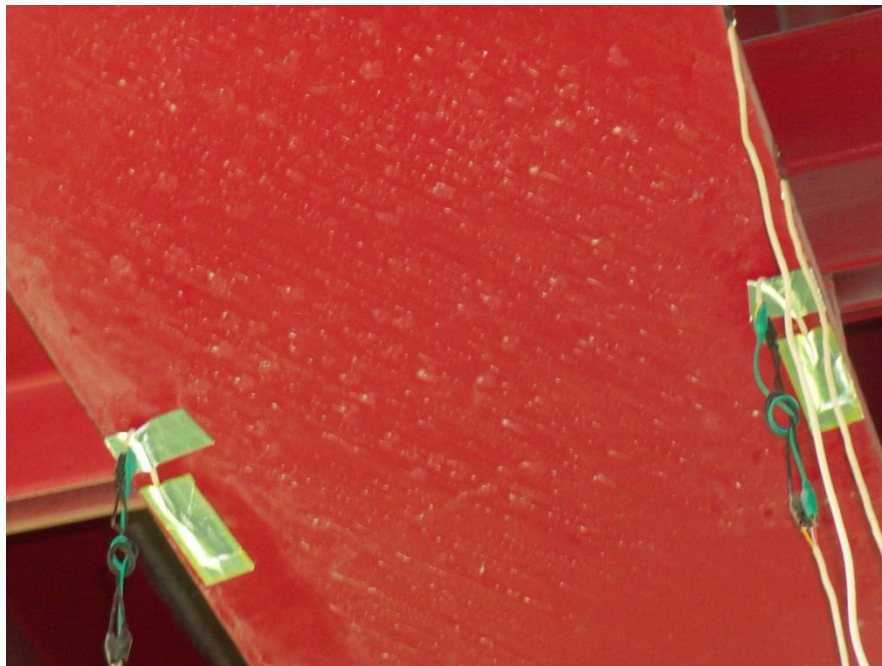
Instalación de los strain gages en las vigas de prueba.
